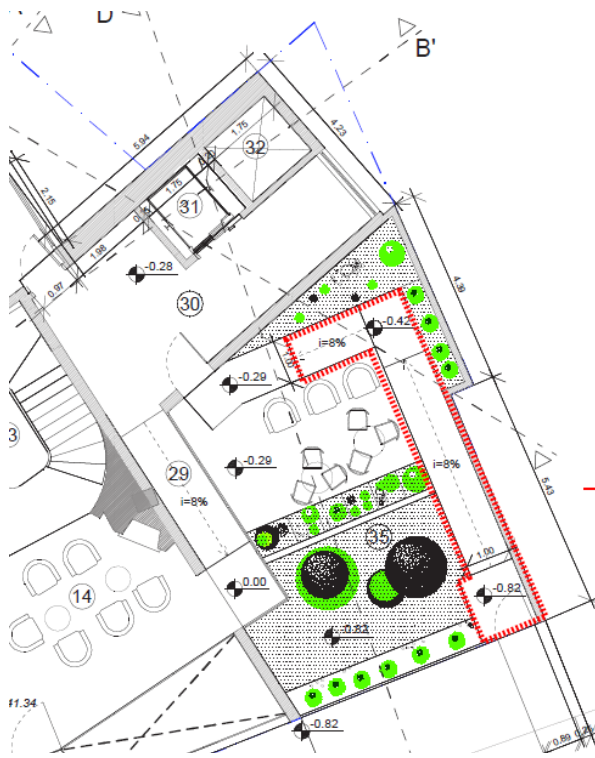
Planta pátio piso 0 [AtelierB2, 2016]
